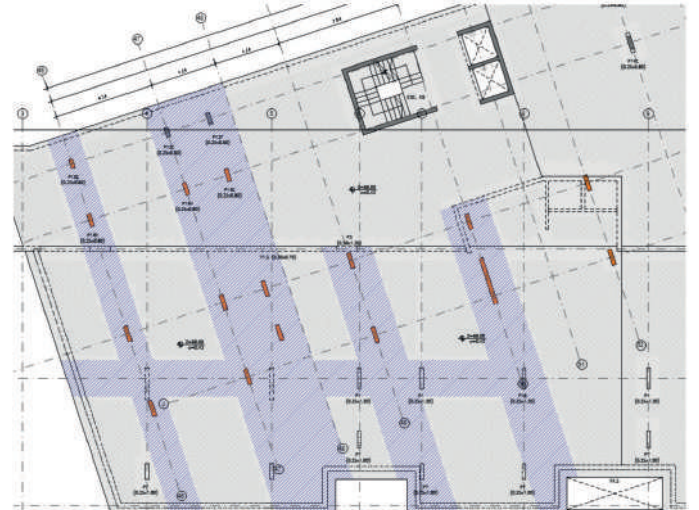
Planta das bandas pré-esforçadas do piso de transição. Prestress strips of transition slab.
